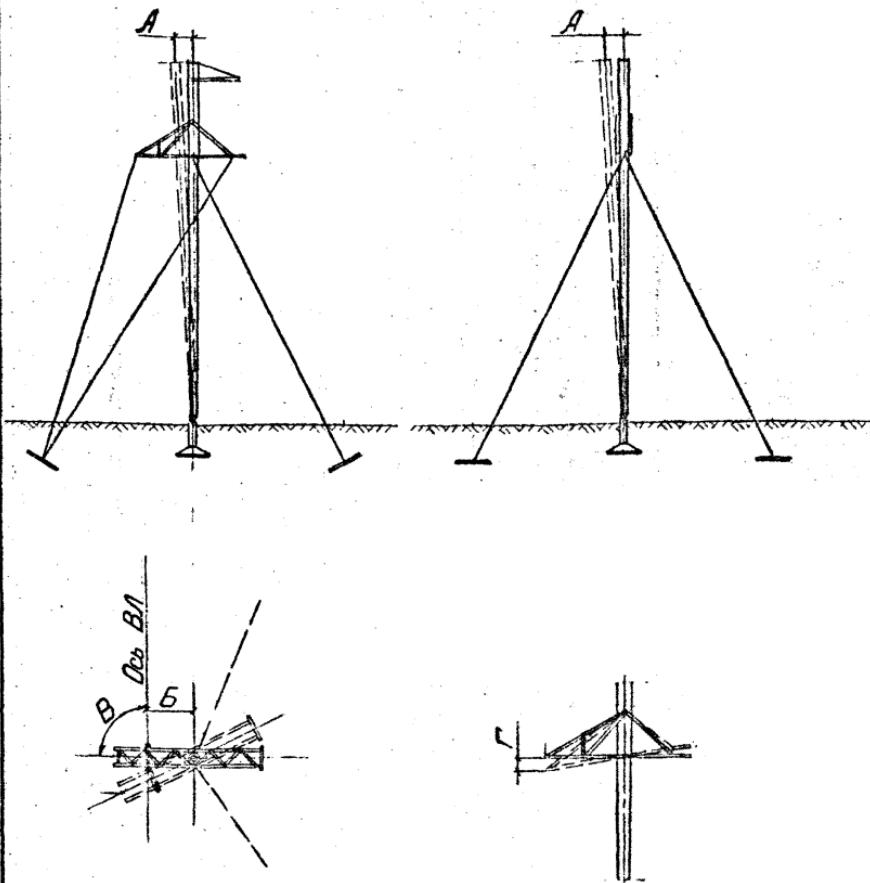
Допуски на установку одностоечных анкерно-угловых железобетонных опор
